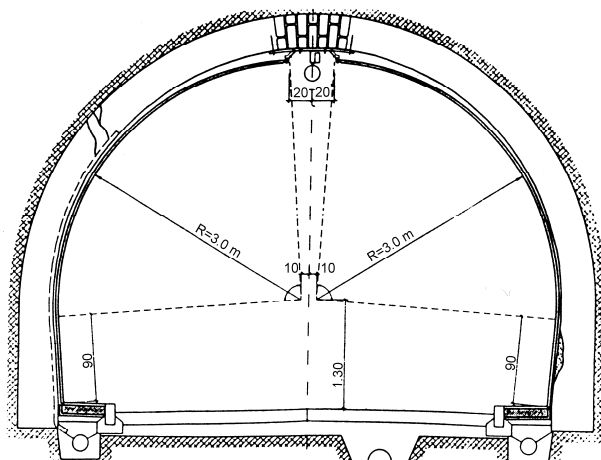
Tunnelquerschnitt mit neuer Auskleidung
